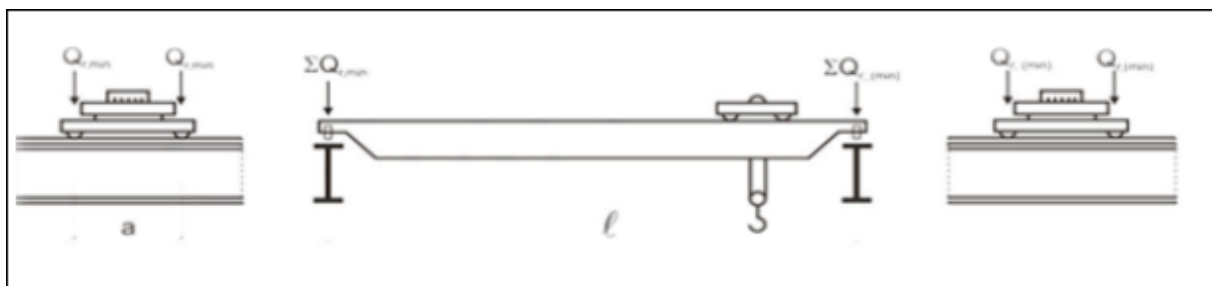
Dispositions de charge de l'appareil de levage à vide pour obtenir un chargement minimal sur la poutre de roulement.
